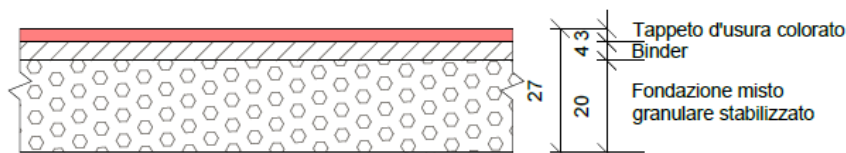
Particolare pacchetto pavimentazione della Pista Ciclabile
